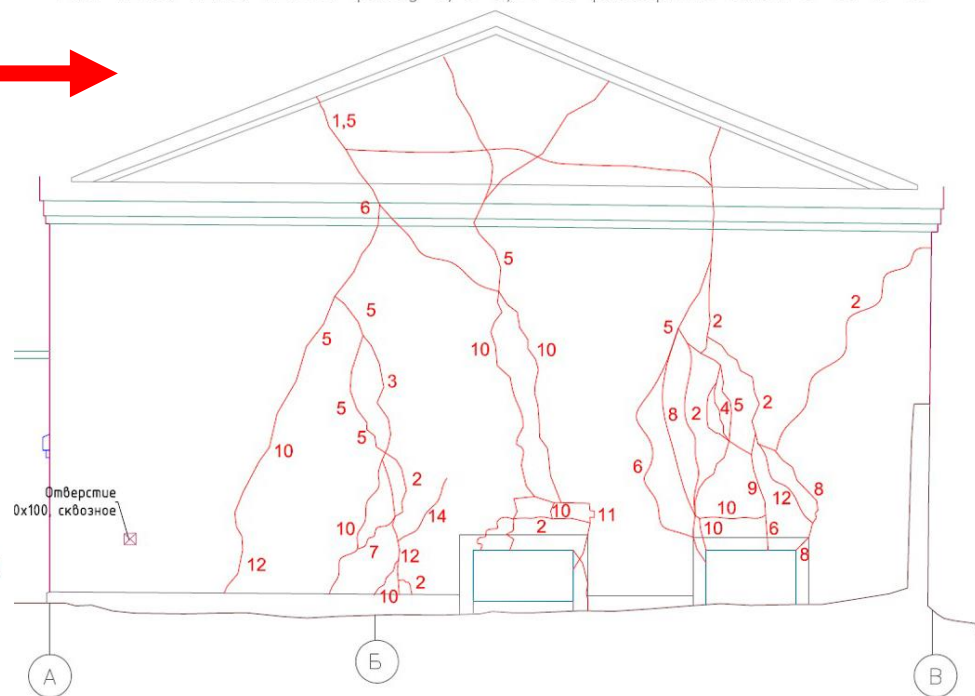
, П1.9, П1.10: фасад в/о 3/А-В, развертки стен 8-8, 6-6.
